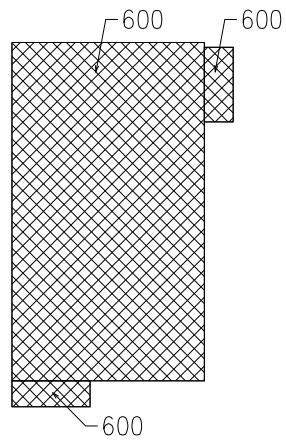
(4/7)  の範囲 (4 階平面図 : EL. 43.5 m)
